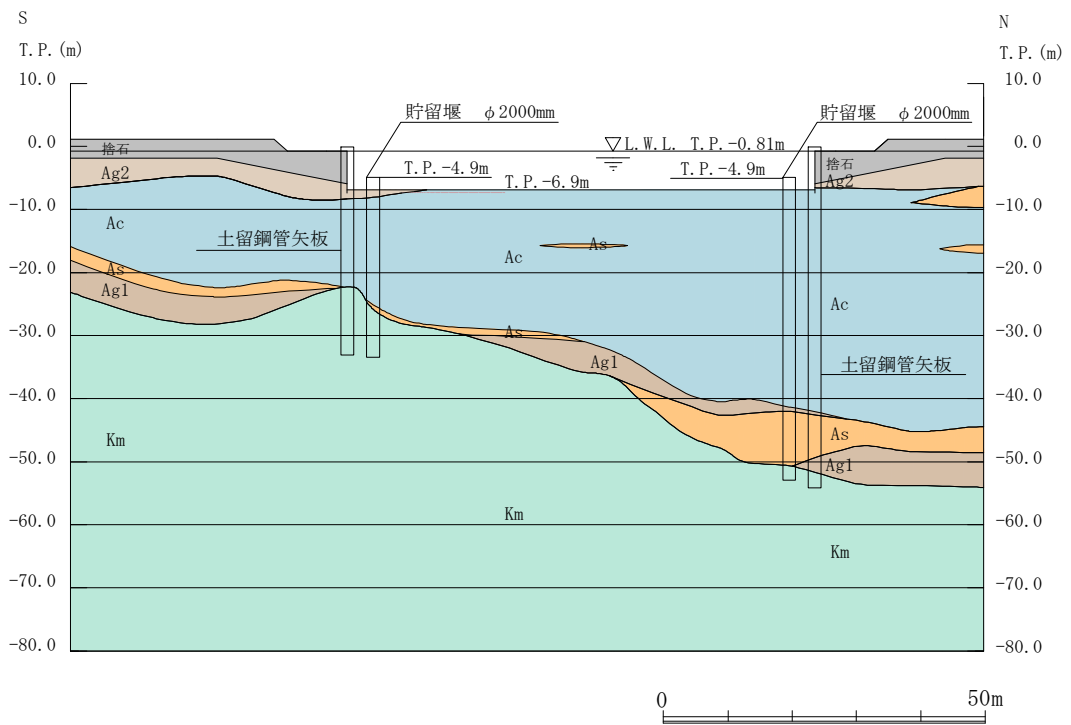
土留鋼管矢板の断面図 (NS-1)
